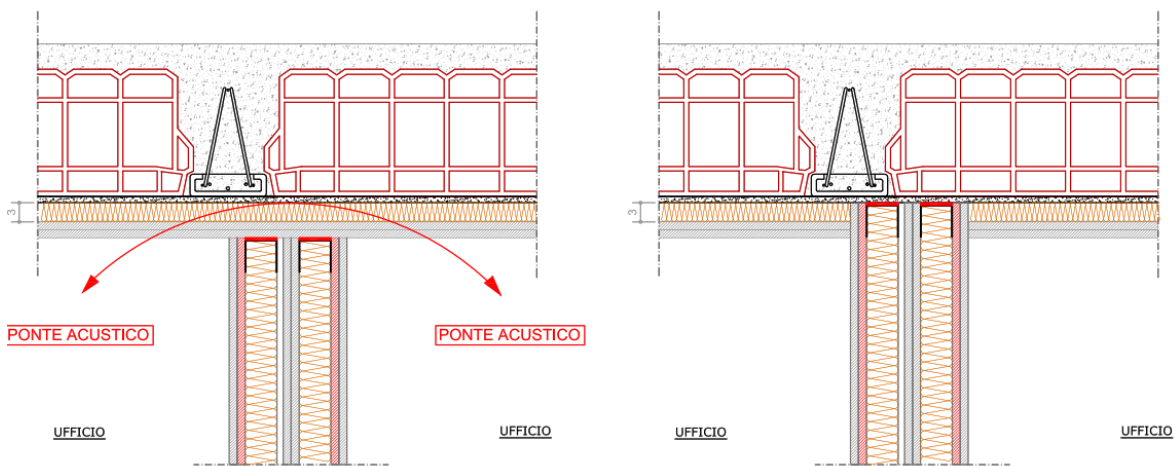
Sezione verticale. Trattamento del ponte acustico tra strutture verticali e orizzontali (controsoffitto e parete interna)
